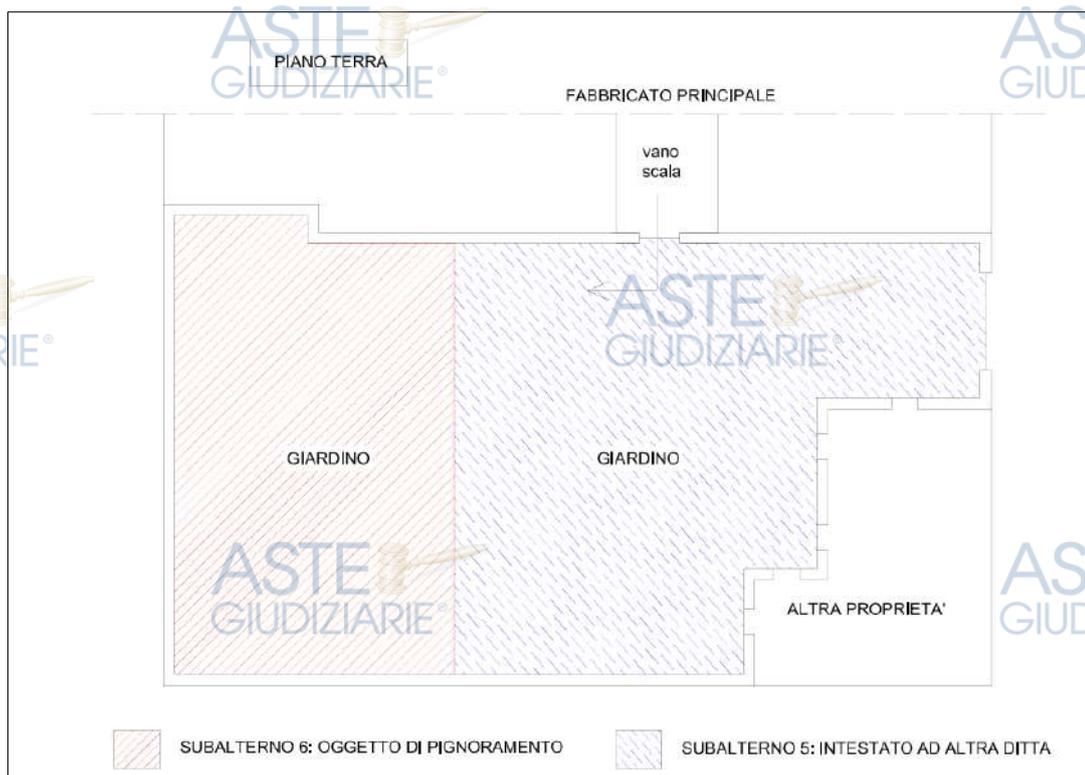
Planimetria dello stato di fatto del Giardino del sub 5 e del sub. 6 al piano terra
